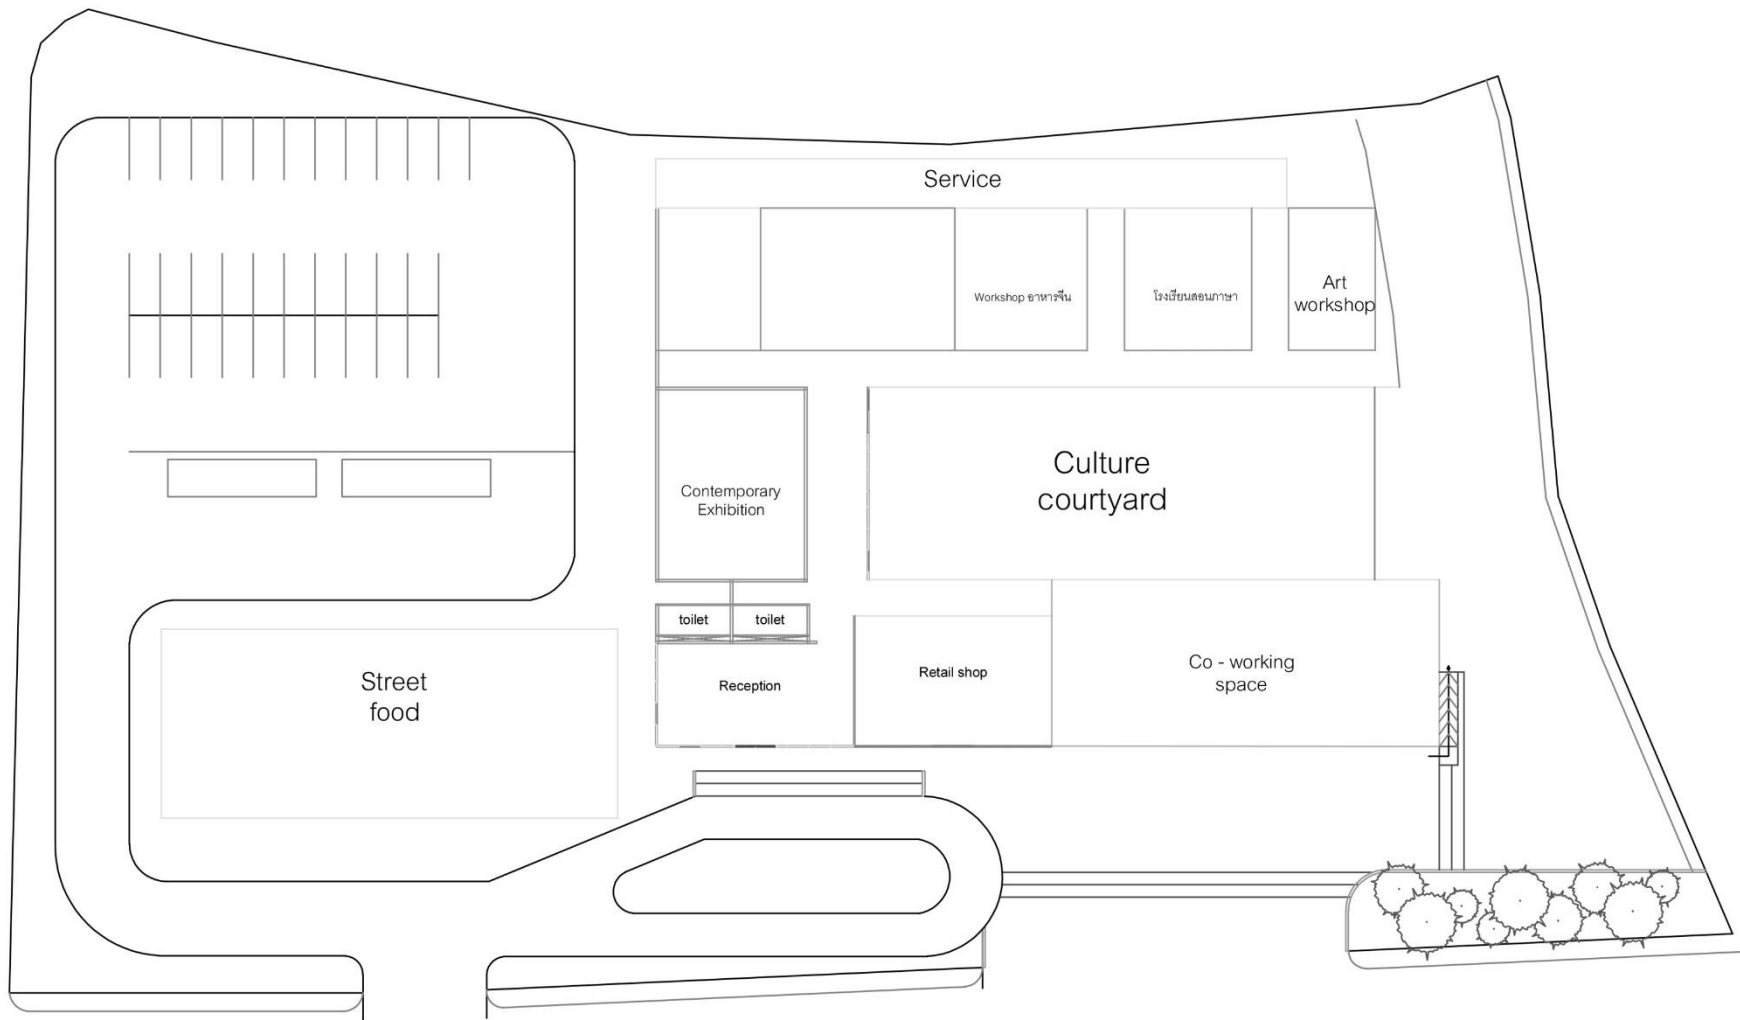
Schematic design 1 - 2nd floor plan - ธันวาคม 2021
